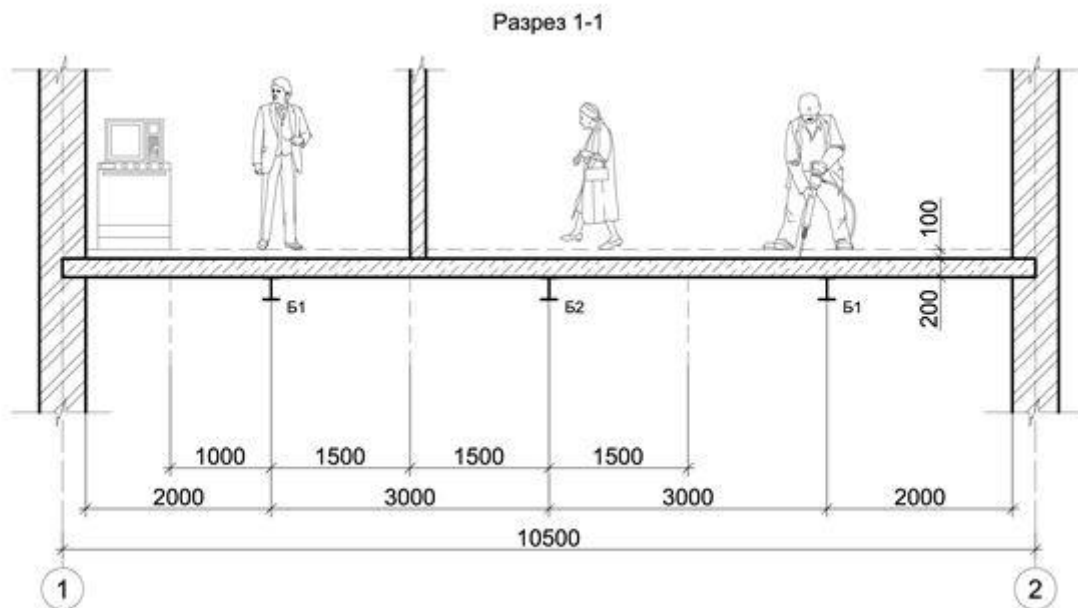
Разрез 1-1, расположение металлических балок перекрытия
